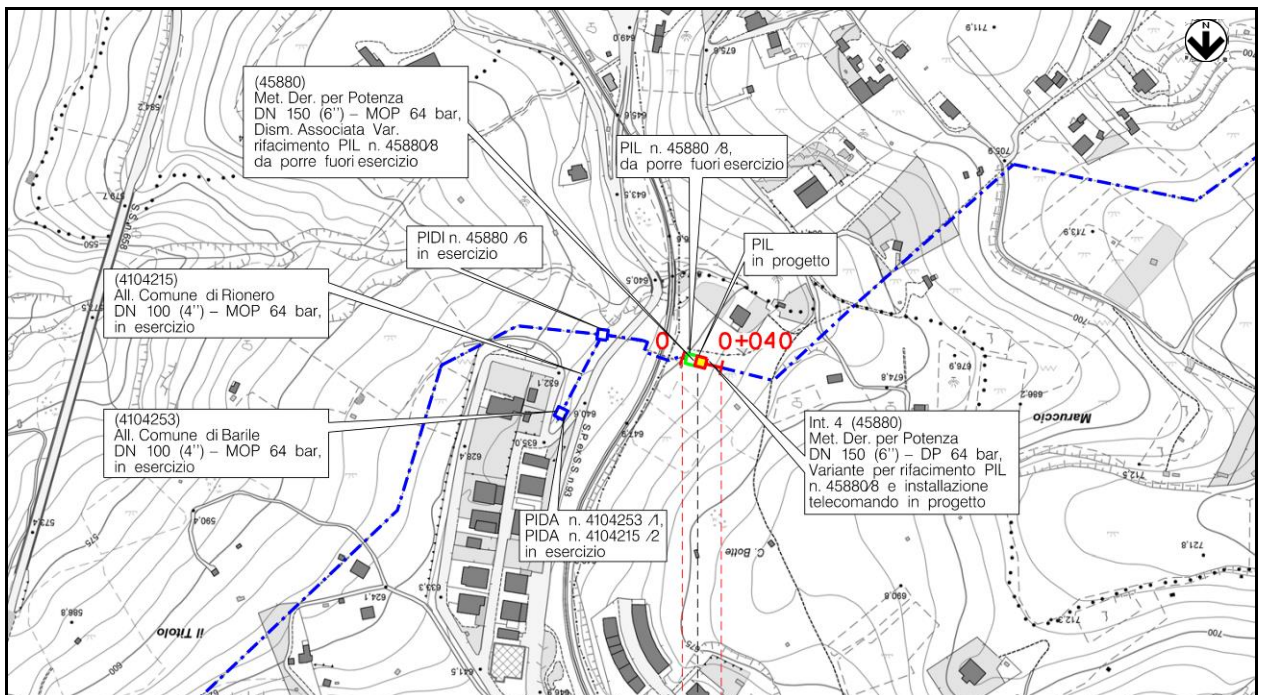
/D.b – Planimetria 1:5.000 con localizzazione dell'area dell'Intervento n.4 (progetto in rosso, dismissione in verde, esistente in blu)
